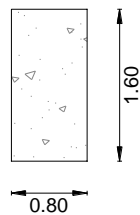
SECÇÃO TRANSVERSAL DAS CARLINGAS DE APOIO
